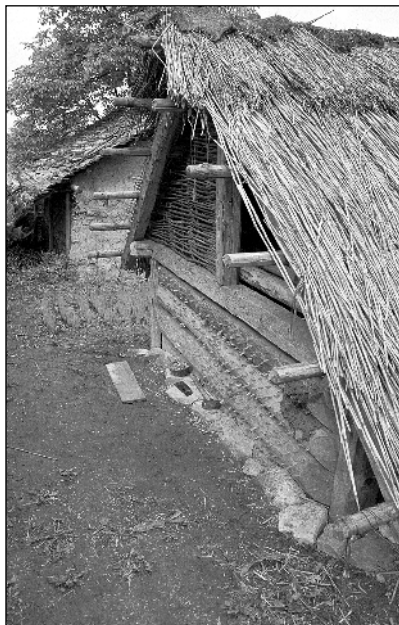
Experimentální stavba objektu B7: hrubá stavba s krovem. (foto na této dvojstránce archiv Archaia) ■
